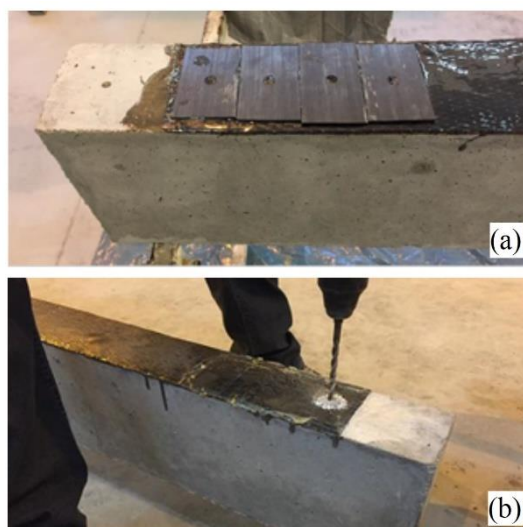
(a): Configuração das vigas do Grupo II; (b): Furação das vigas do Grupo II para colocação dos parabolts
